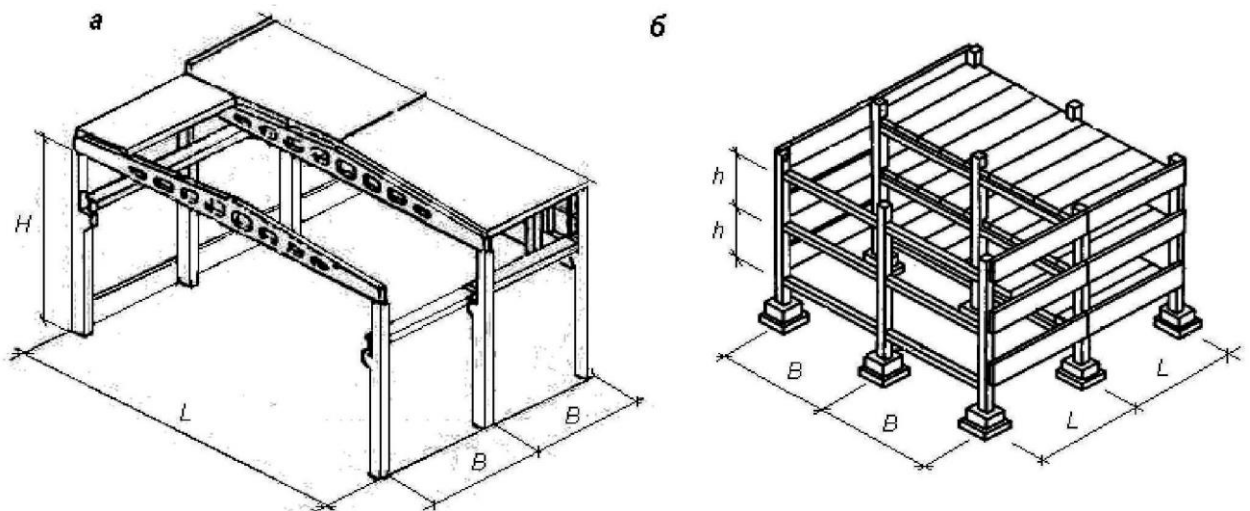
Основні параметри об'ємно-планувального вирішення виробничих будівель: *a* – одноповерхових; *б* – багатоповерхових; *L* – проліт; *B* – крок; *H* – висота одноповерхової будівлі; *h* – висота поверху
